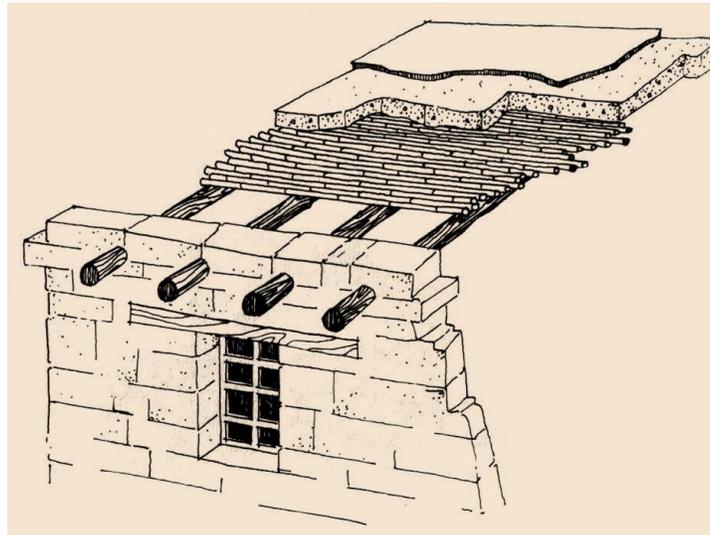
Detalle de los componentes para la construcción de una cubierta plana.
